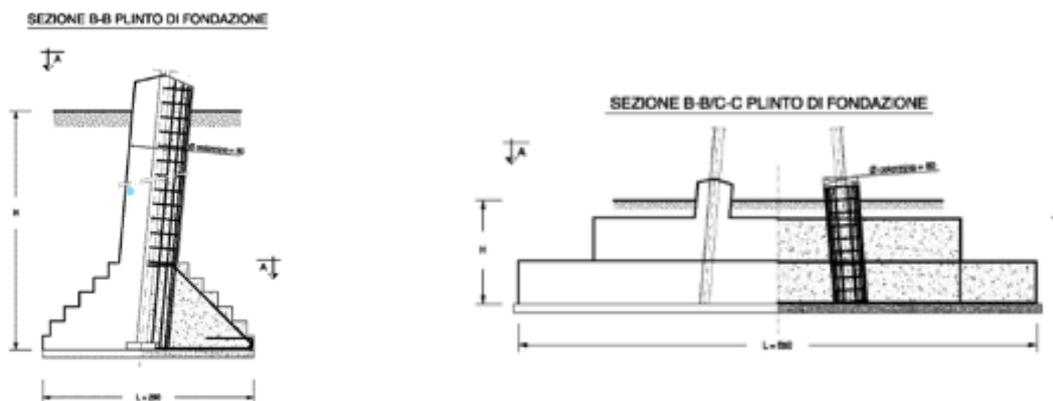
Schema fondazione tipo (Fonte:TERNA)
